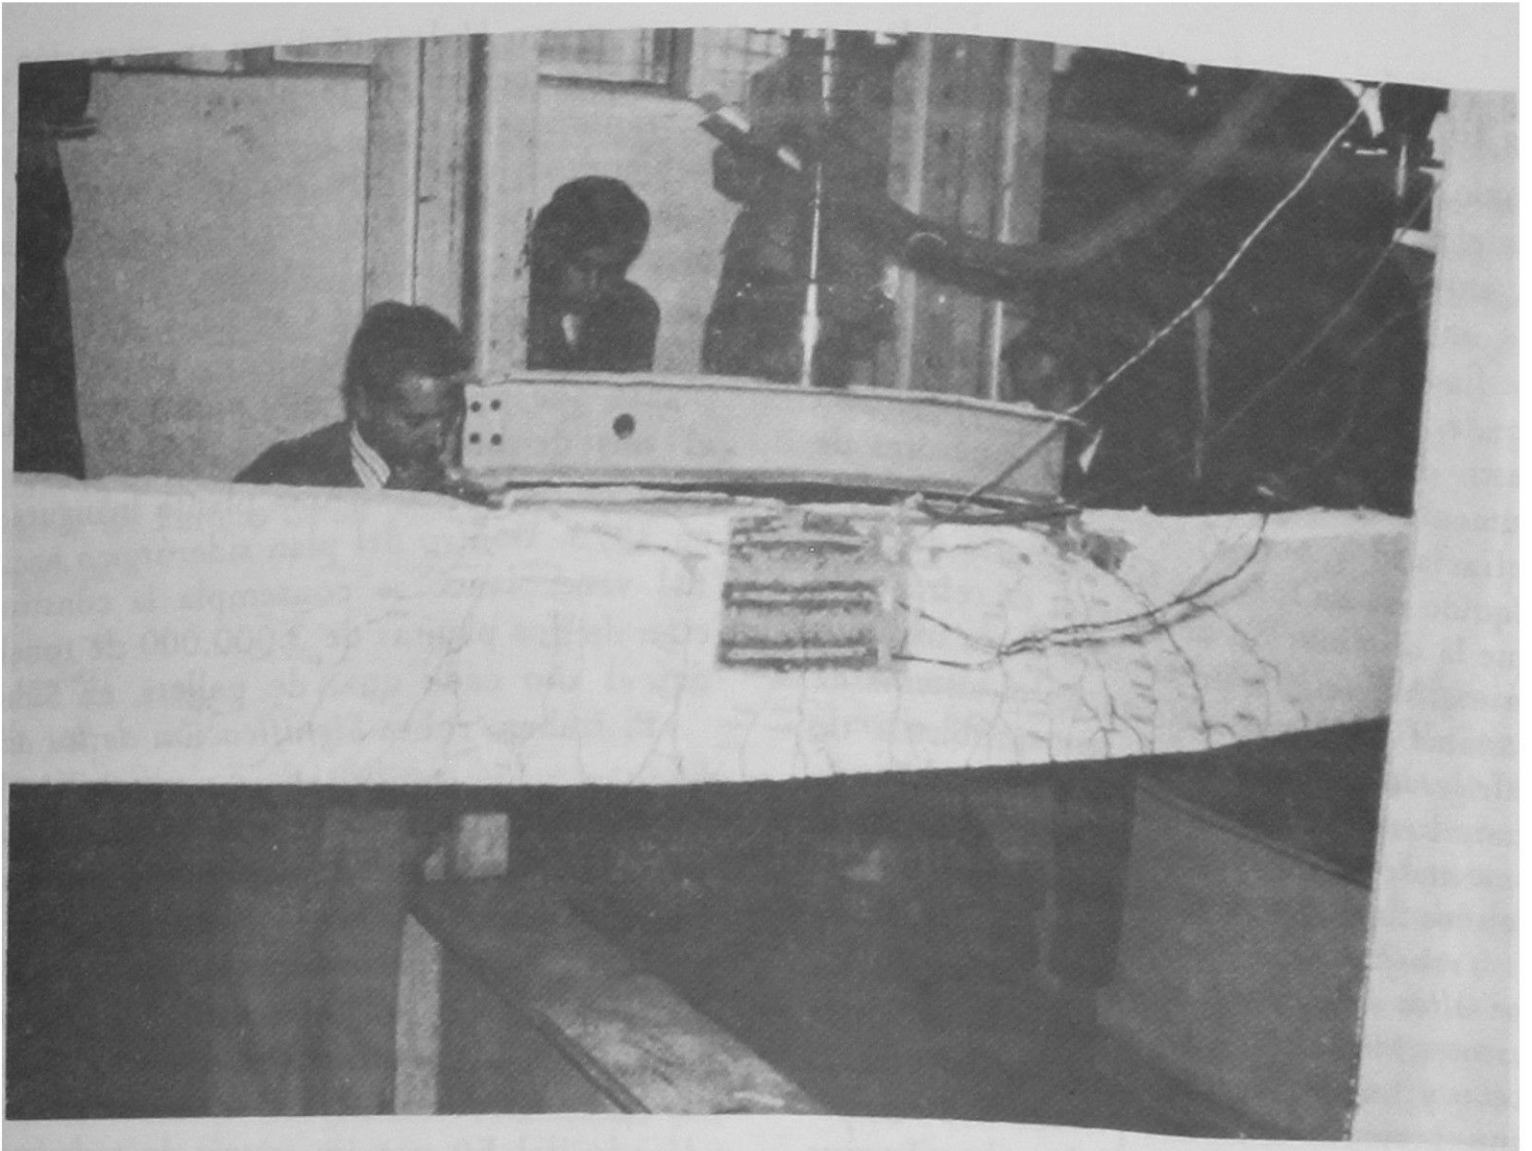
Ensayo a la flexión de una viga de hormigón armado.
